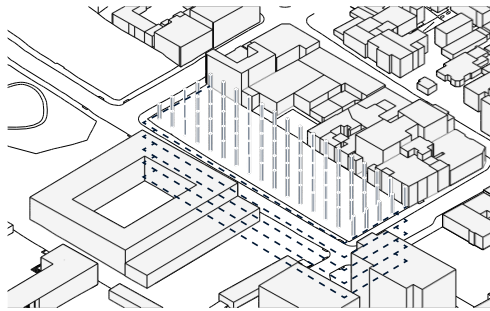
"Soportales en planta baja". Elaboración propia.
